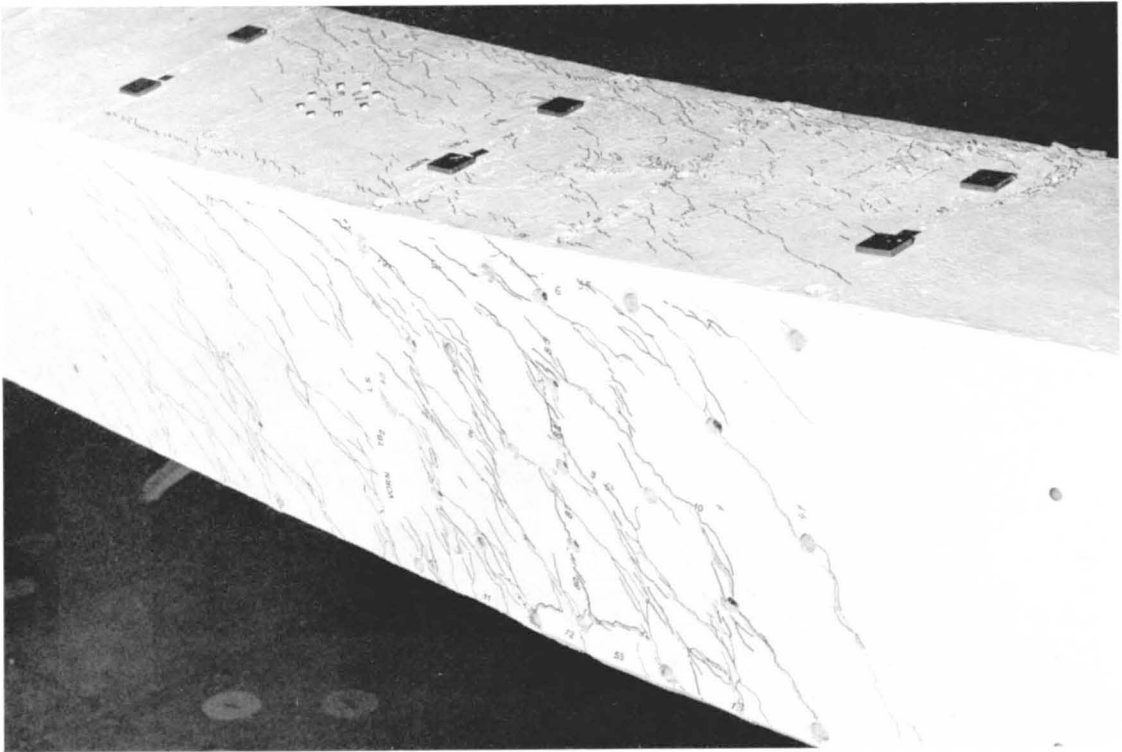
(a): Bruchbereich Balken TB_2 (oben, vorn)
